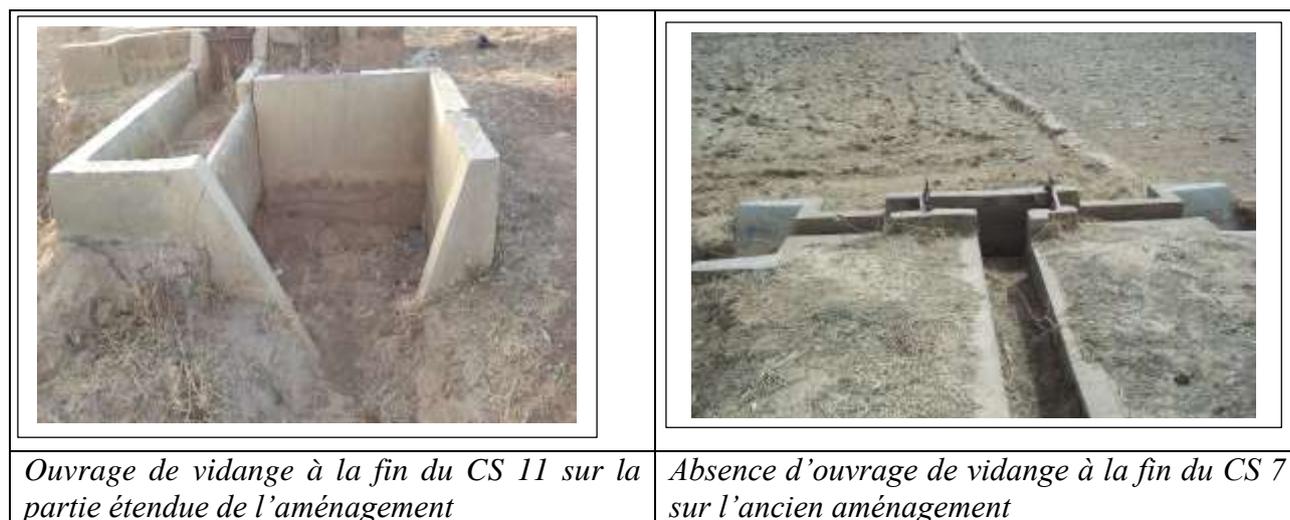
Ouvrages de vidange sur Canal primaire et canaux Secondaires
